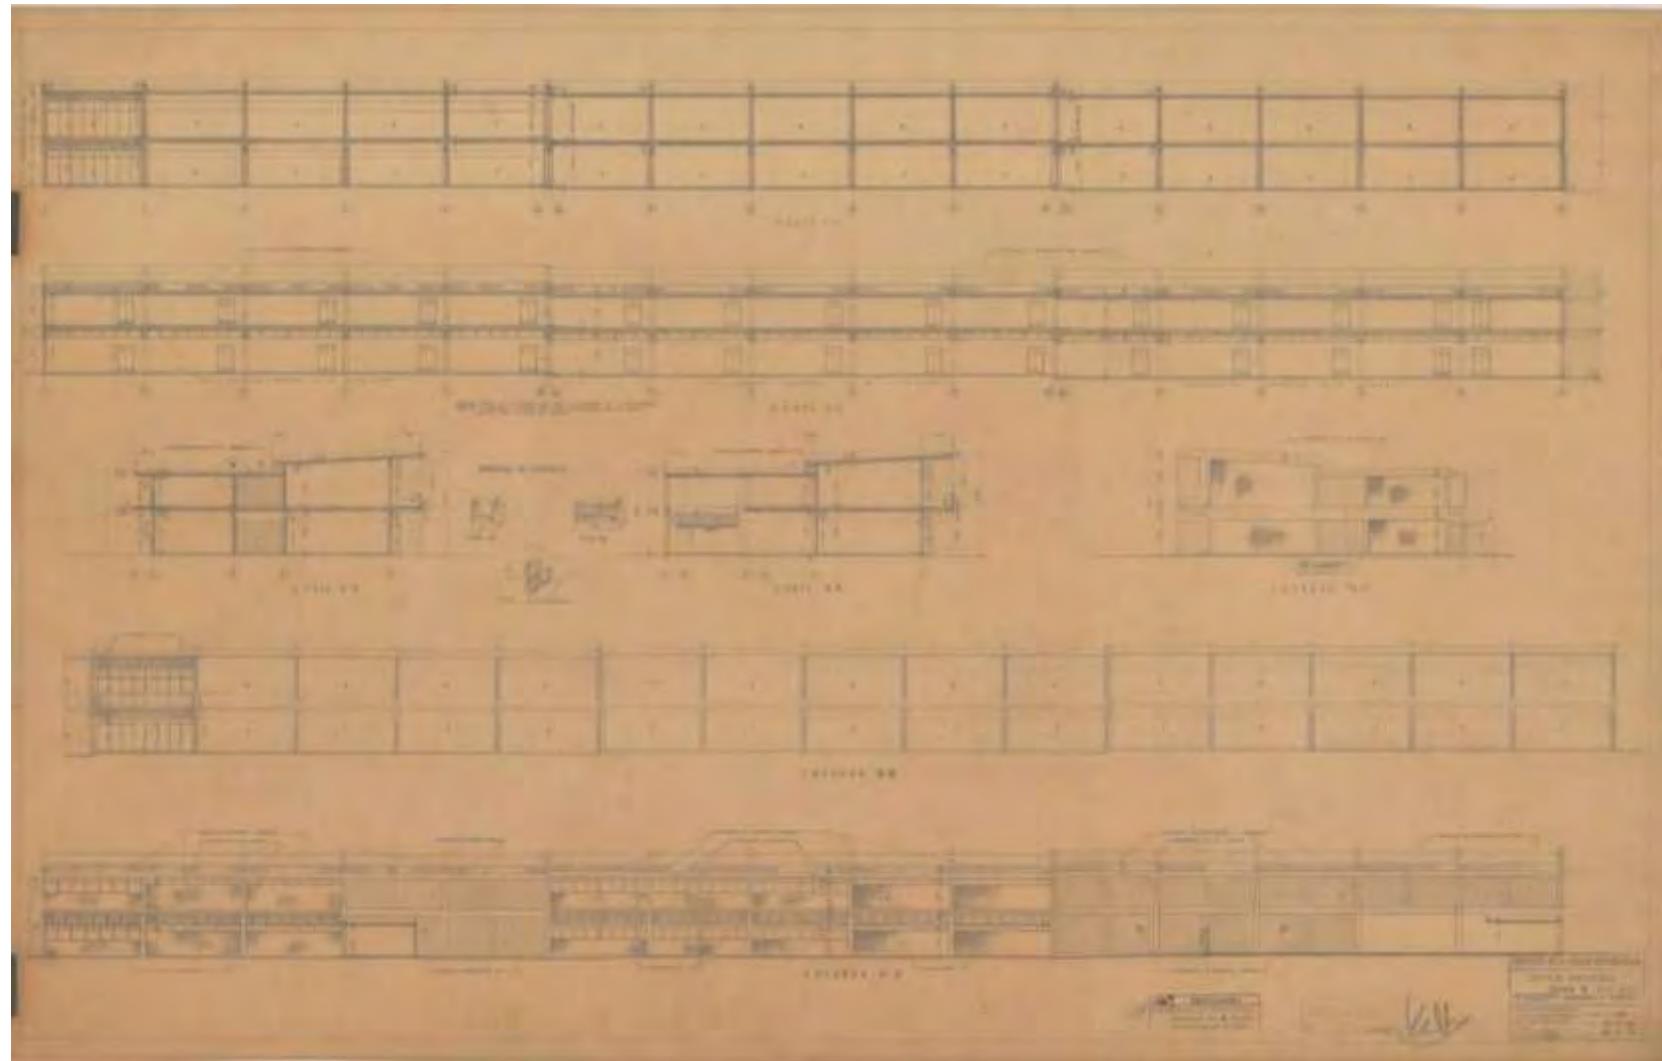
Plano 36-A-13. Sección B parte Norte Fachadas y Cortes Facultad Filosofía y Letras. Fuente: Colección CUC-ICU / COPRED-UCV.
